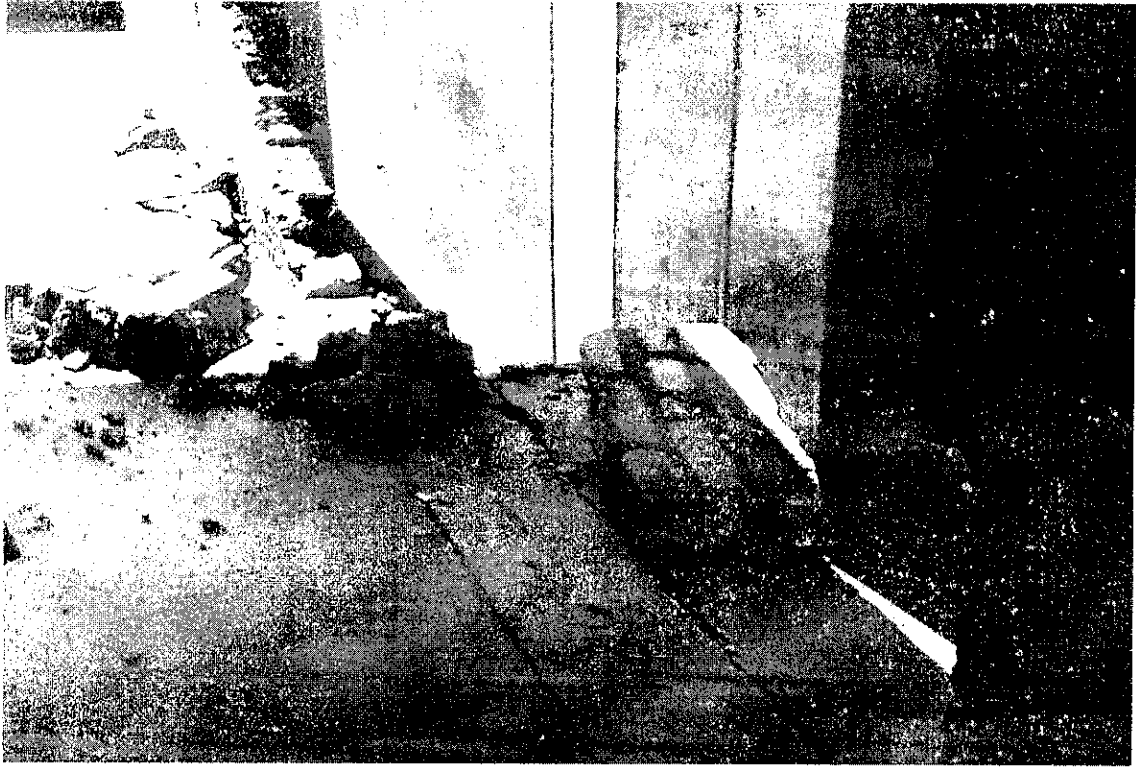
PARAPETO EN 2° PISO COLAPSADO.
